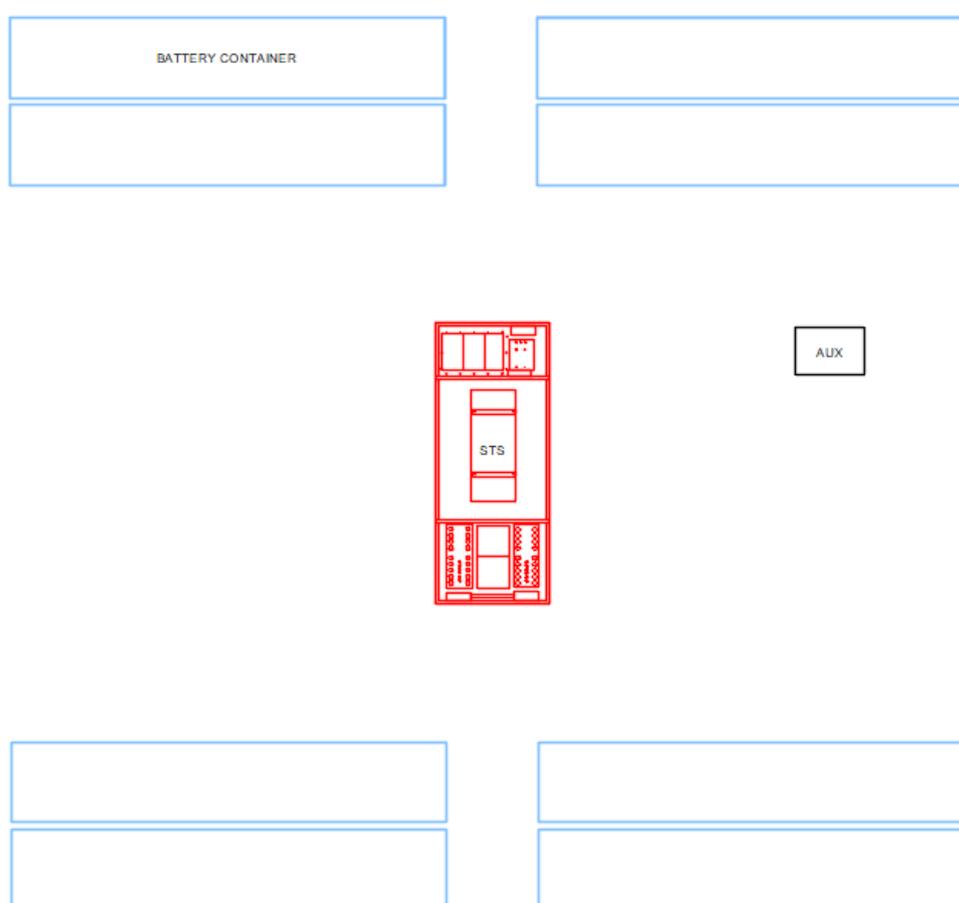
Layout tipico di una unità di accumulo da 3,00 MW
